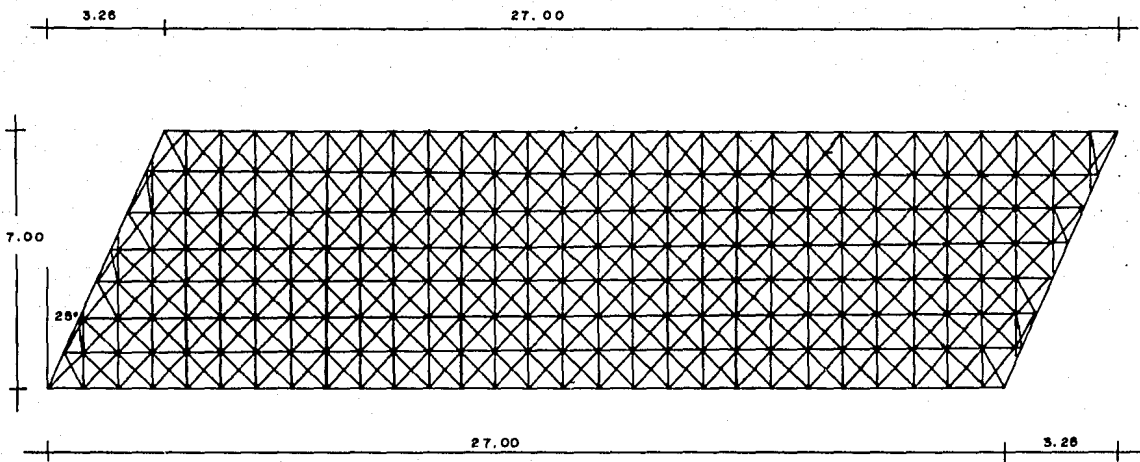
PLANTA GENERAL DE LA ESTRUCTURA ESPACIAL
